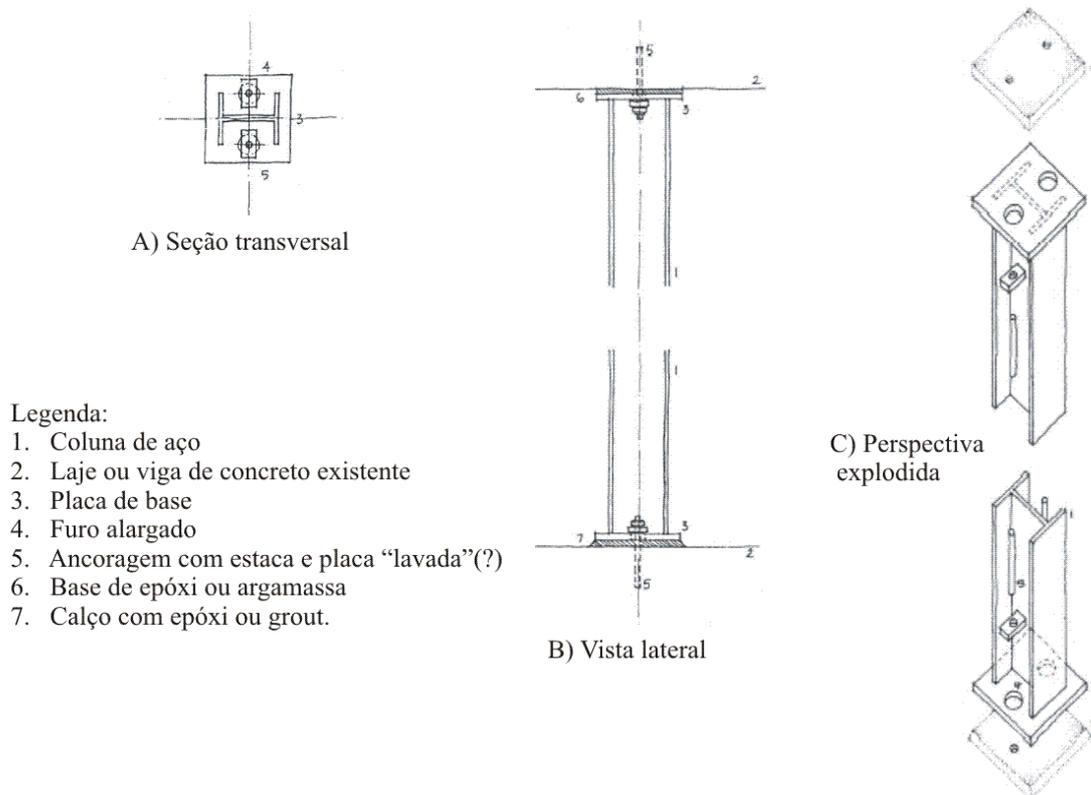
Reforço com nova coluna de aço em que sua fixação na base com dois chumbadores constitui uma boa solução de ligação rotulada com laje ou viga de concreto.
